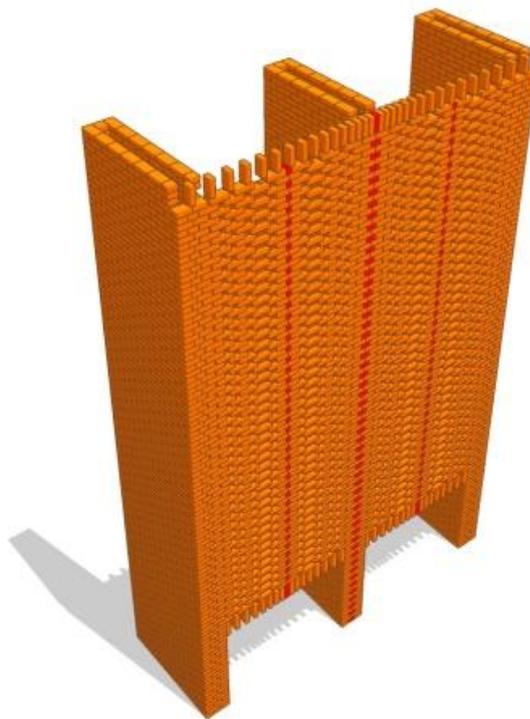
A parede da fachada leste. Em vermelho, a marcação da “costura” feita na coluna de tijolos. A linha, que se encontra no centro dos pilares, marca o encontro horizontal dos tijolos. No topo, a platibanda do muro é todo composto por tijolos em pé (soldier course), finalizados pela pingadeira em concreto. Ilustração feita pelo autor, 2021.
